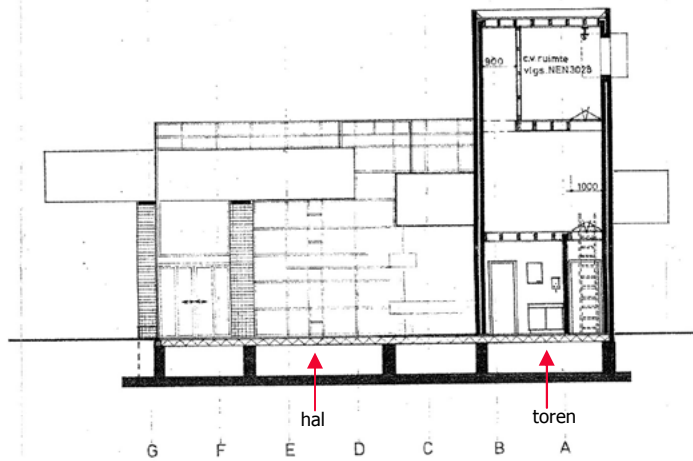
Doorsnede van het stationsgebouw, oost-west, door de wachtruimte en de hal. Het dakvlak boven de wachtruimte steekt ver door buiten het gebouw en rust op een vrijstaande muur aan de oostzijde. Detail van de bestekstekening 1981
